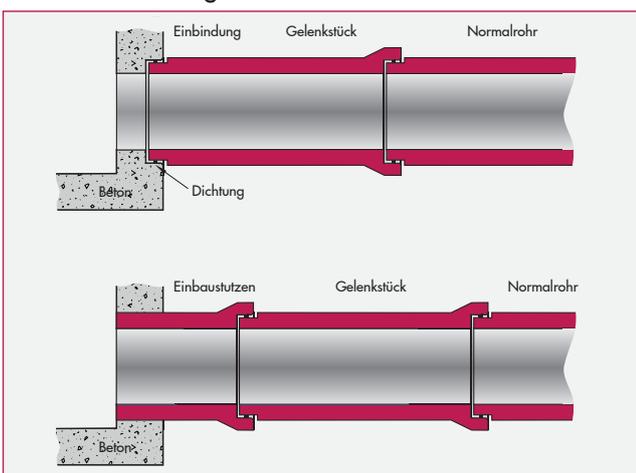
Mögliche Varianten eines Rohranschlusses an ein Bauwerk
